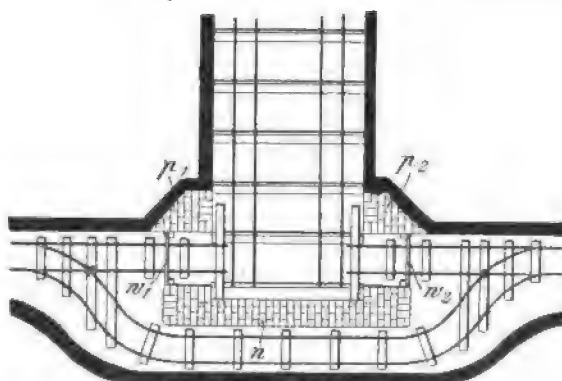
<sup>1)</sup> Anschlag mit Schutzmauer bei flacher Lagerung (Grundriß).
